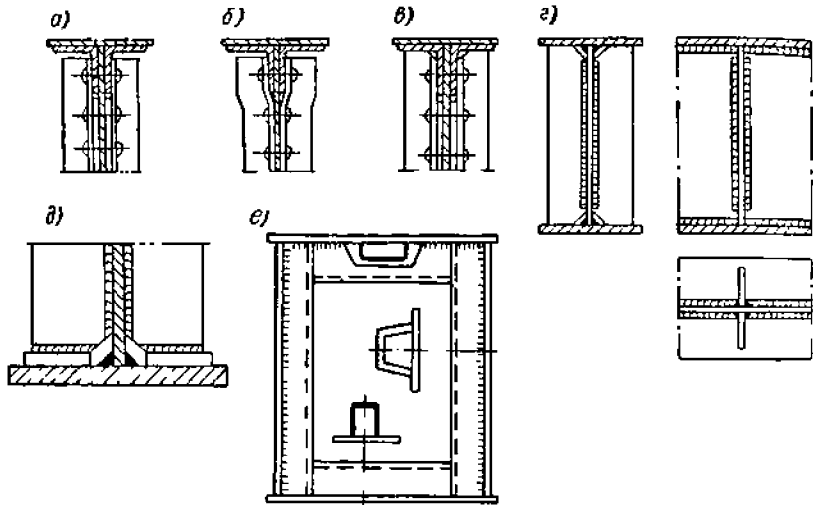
Укрепление стенки клепаной балки уголками жесткости (а, б, в), а стенок сварных балок полосовыми (г, д) или коробчатыми (е) ребрами жесткости
